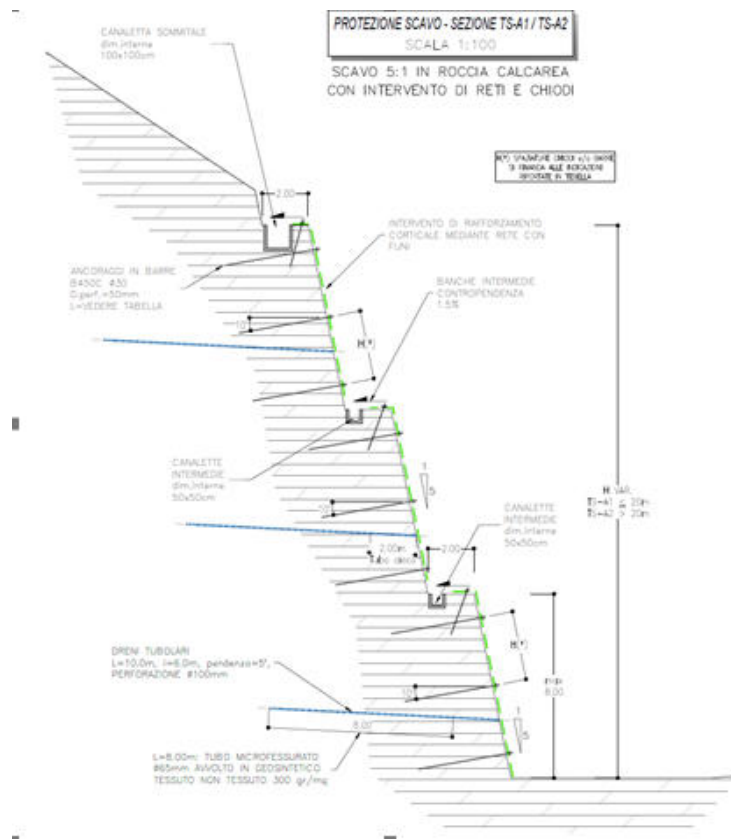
Sezione tipologica trincea e intervento di protezione scavi TS-A.
